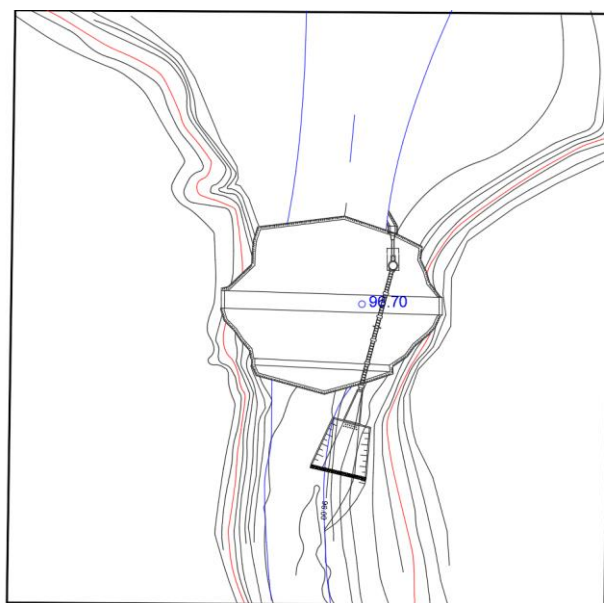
Генеральний план гідровузла з ґрунтовою греблею
